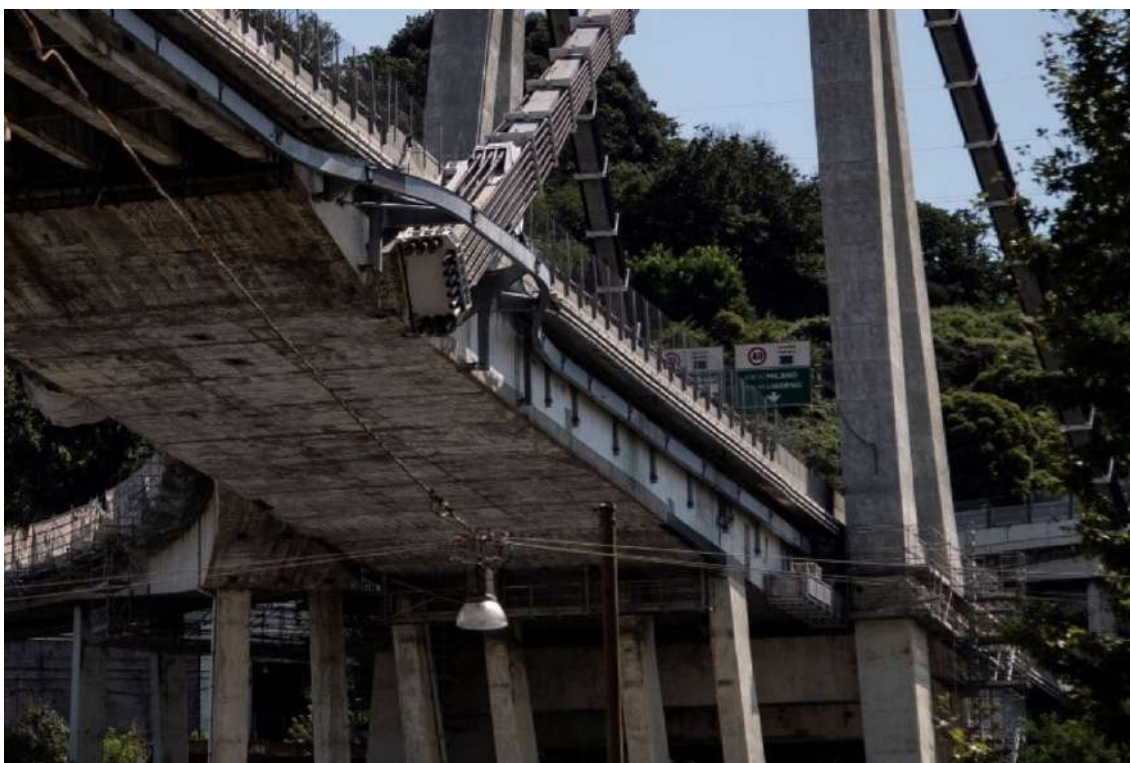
Vista do reforço de um dos estais da Ponte. Fonte:
